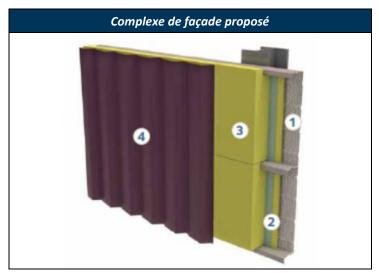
Complexe de façade proposé pour la création d'un bâtiment technique ATAWEY
